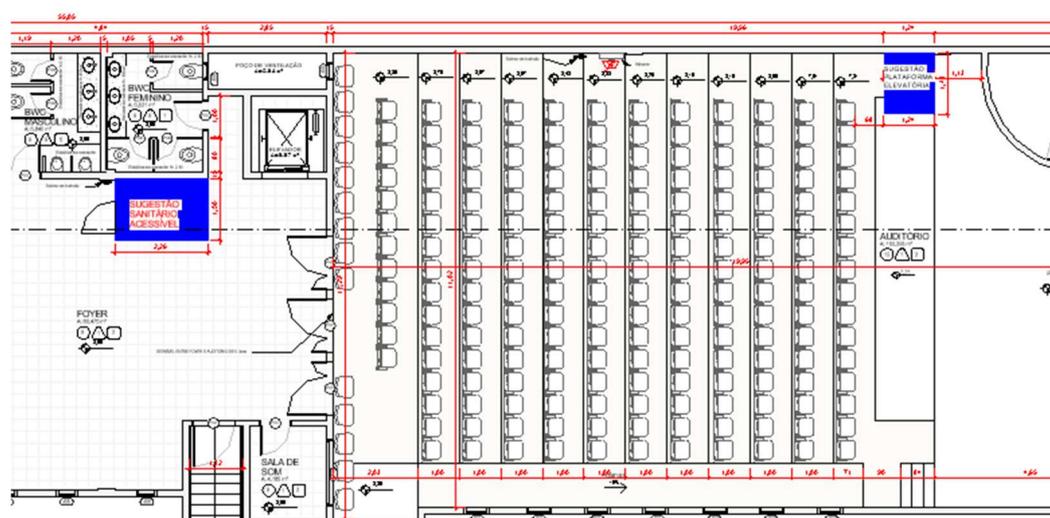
Sugestão sanitário acessível 2º pavimento e localização aparelho eletromecânico de acesso ao palco.
